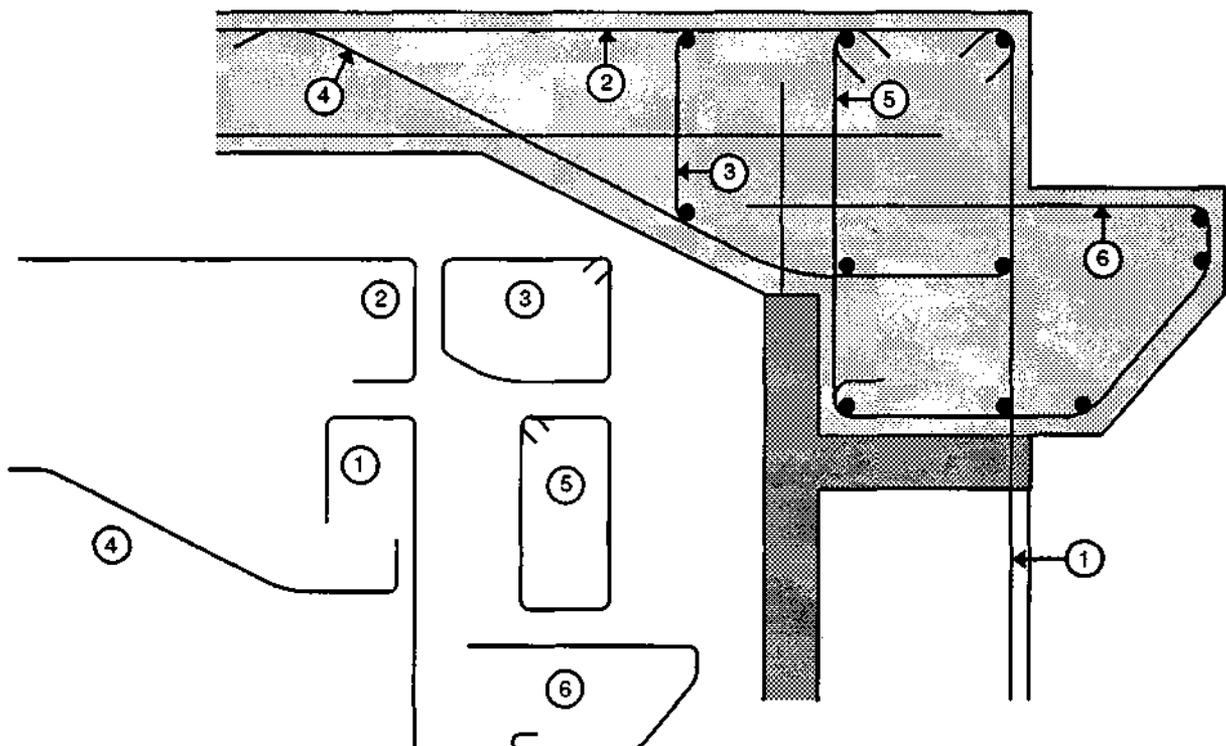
Principe de ferrailage de l'ouvrage de la figure 68
